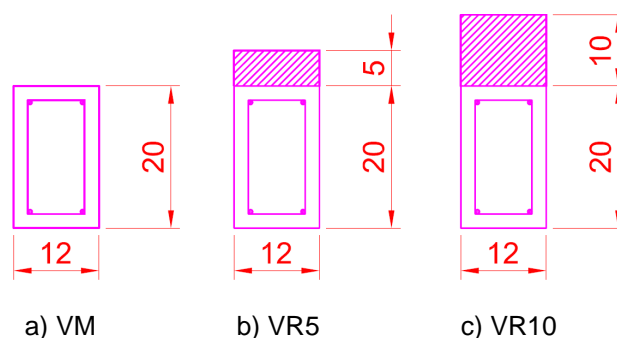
Seção transversal das vigas a serem ensaiadas antes e após o reforço
